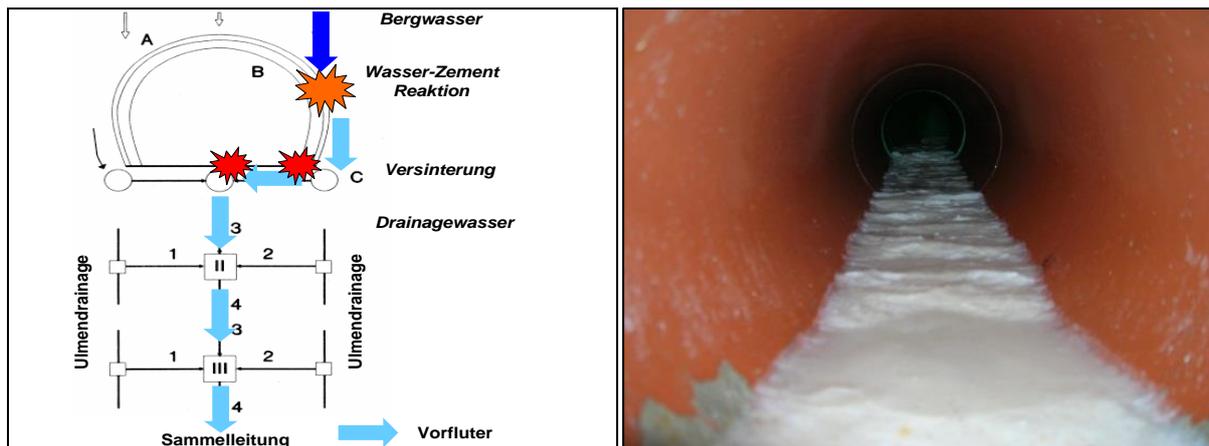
Schematischer Querschnitt und Grundriss des Drainagesystems von Tunnelbauten; Ansicht einer Tunneldrainage mit Calcit-Ausfällungen
